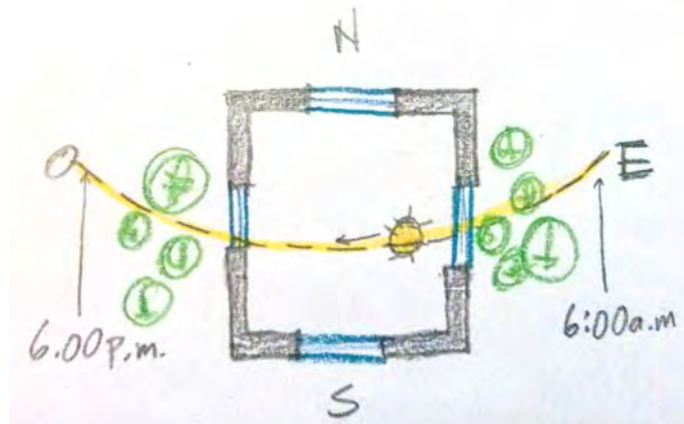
Protección solar con vegetación. (Fuente: Autor).
